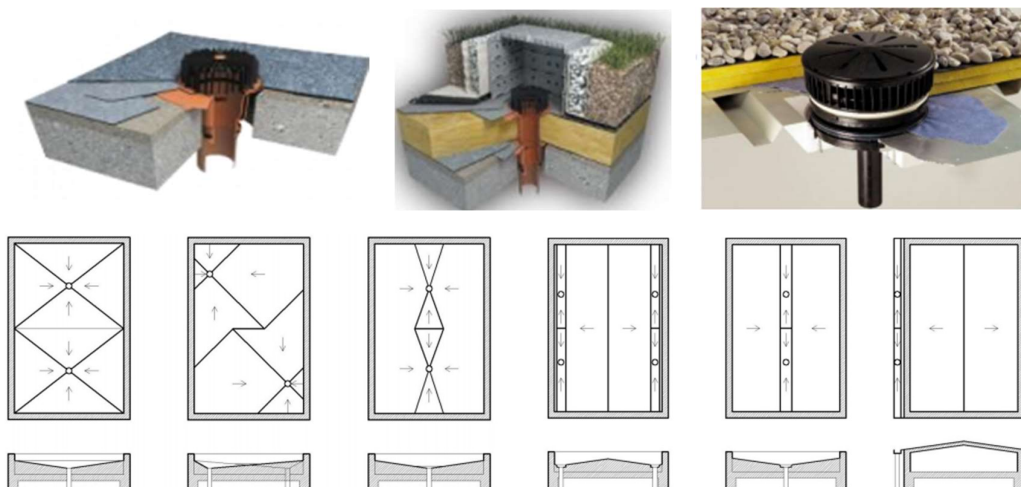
detaily nouzových vtoku – půdorysný vzhled
